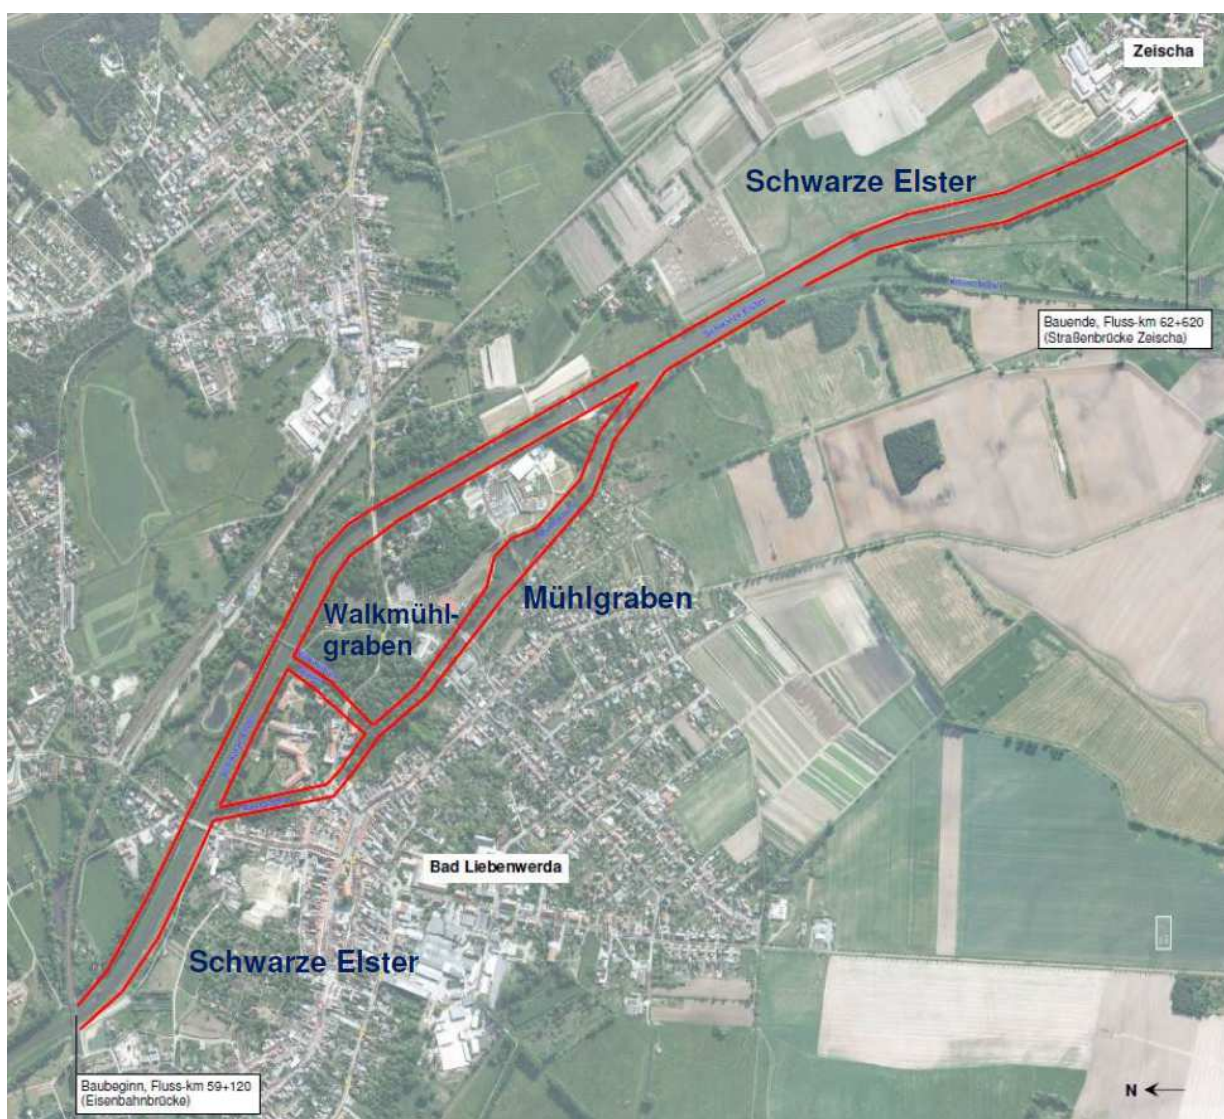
Übersichtslageplan Bad Liebenwerda mit Hochwasserschutzanlagen
